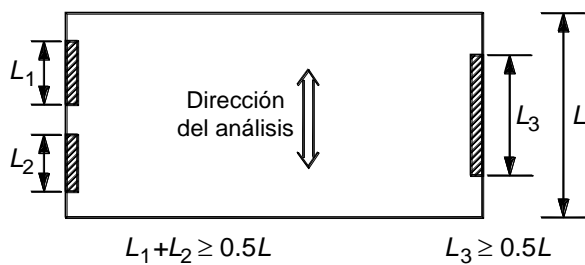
Requisito sobre muros de carga perimetrales paralelos
